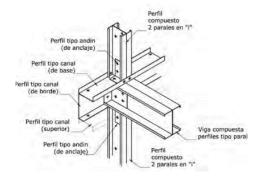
Perfiles Metálicos. FUENTE: Estructura Metálica de Soporte Camacol-Valle
